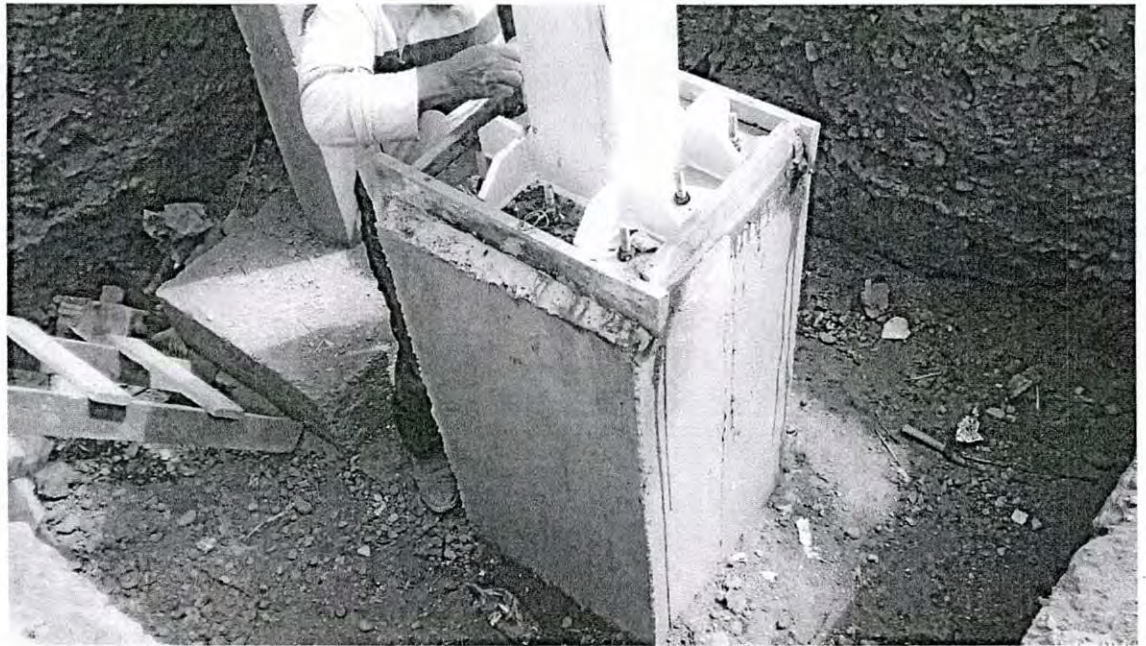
Cimbra y Colocación de FesterGrout NM 800
